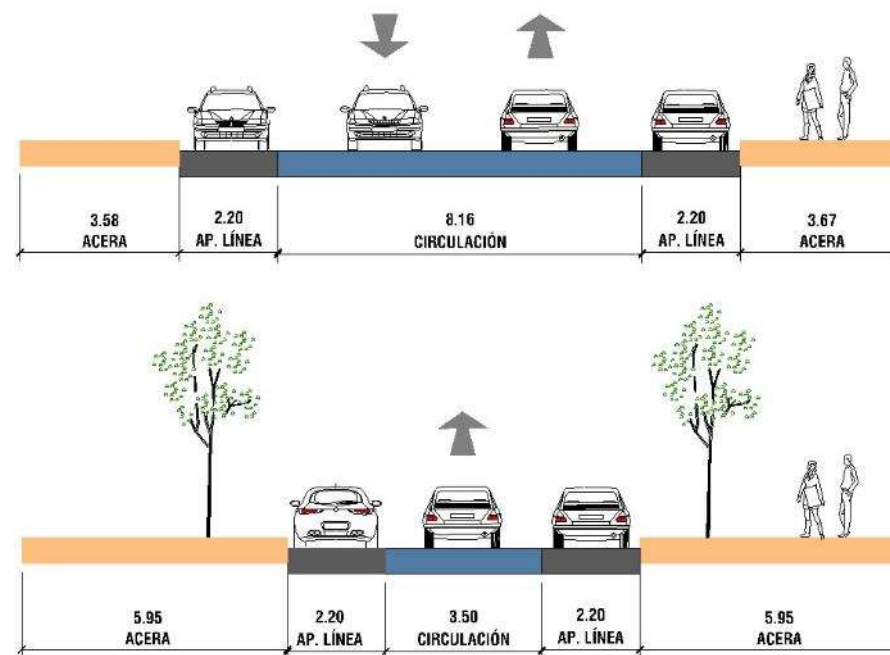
Sección tipo A propuesta en calle Real. Fuente: DOYMO.
